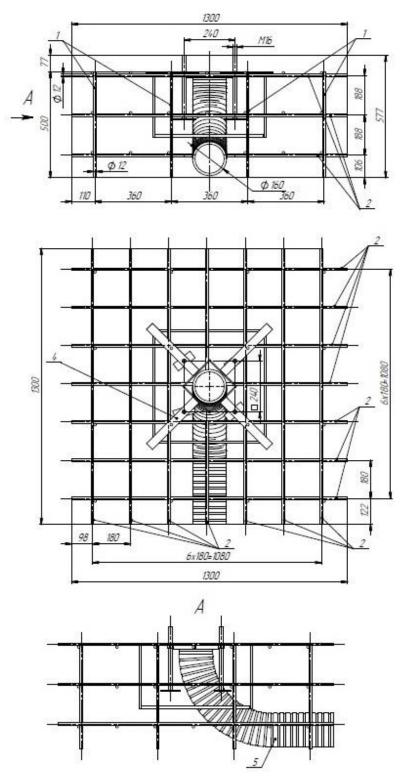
Схема з розмірами армування та складових бетонної основи
